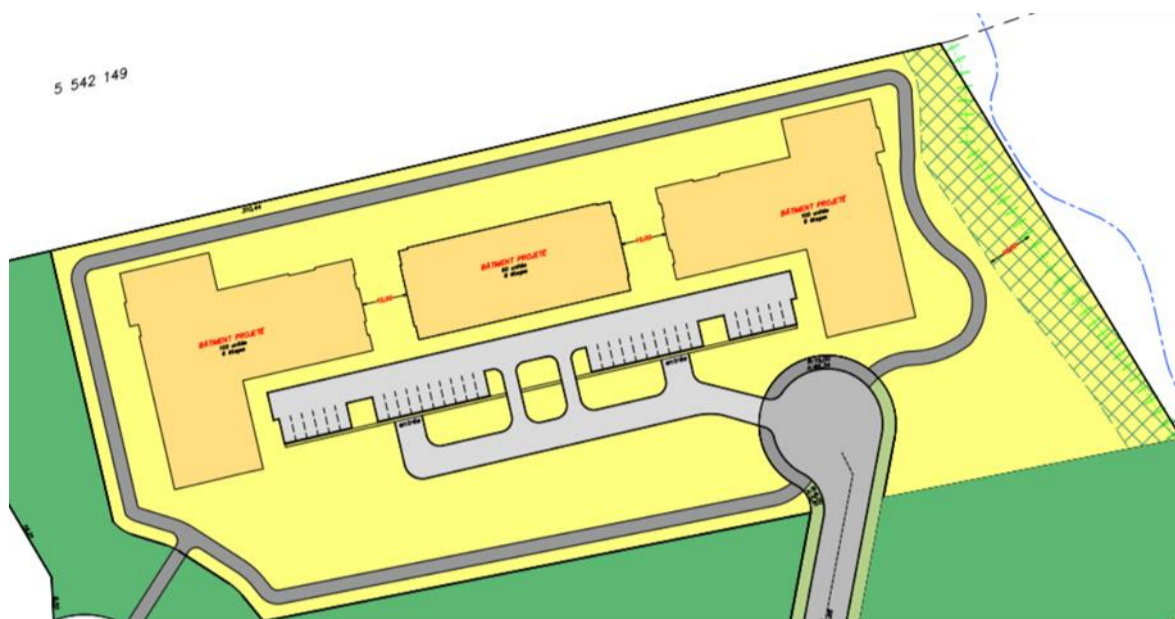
Plan d'aménagement d'ensemble des zones R-12 et CONS-6.
